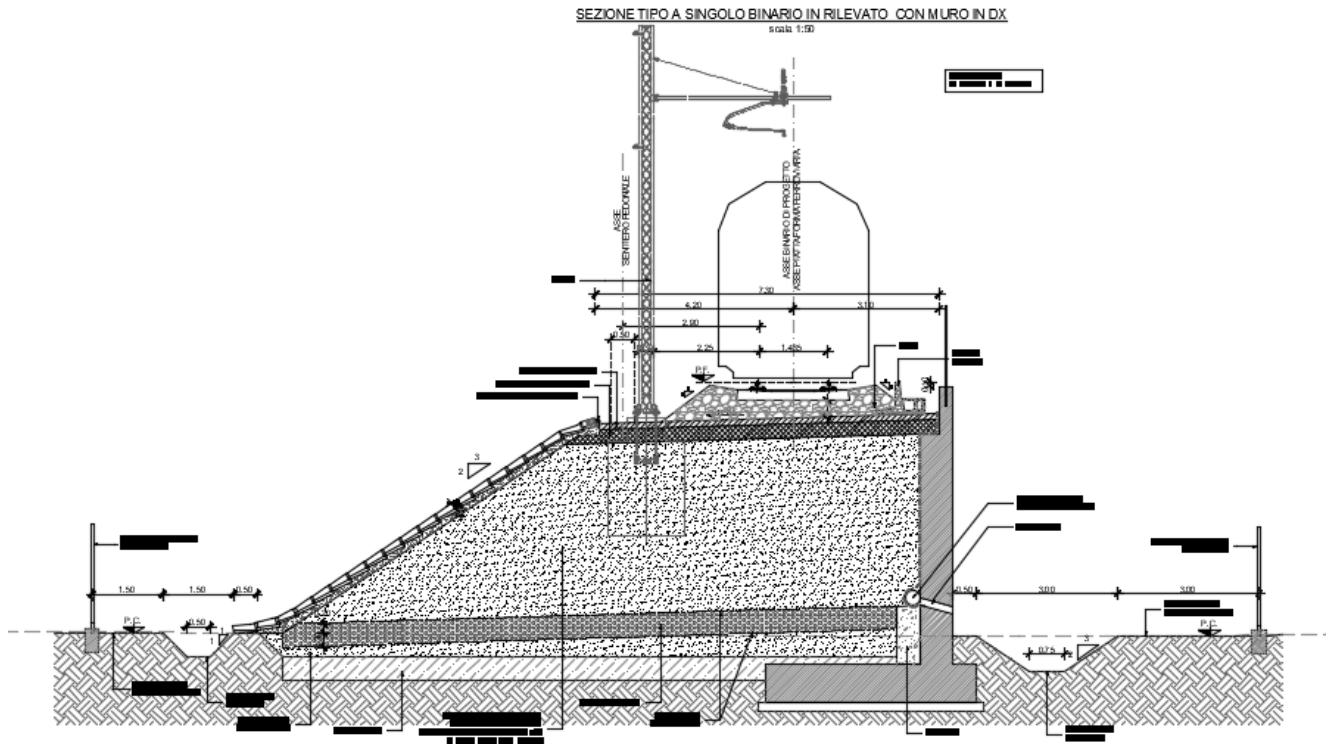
Sezione tipo SB in rilevato con muro in destra - asta L=750m
